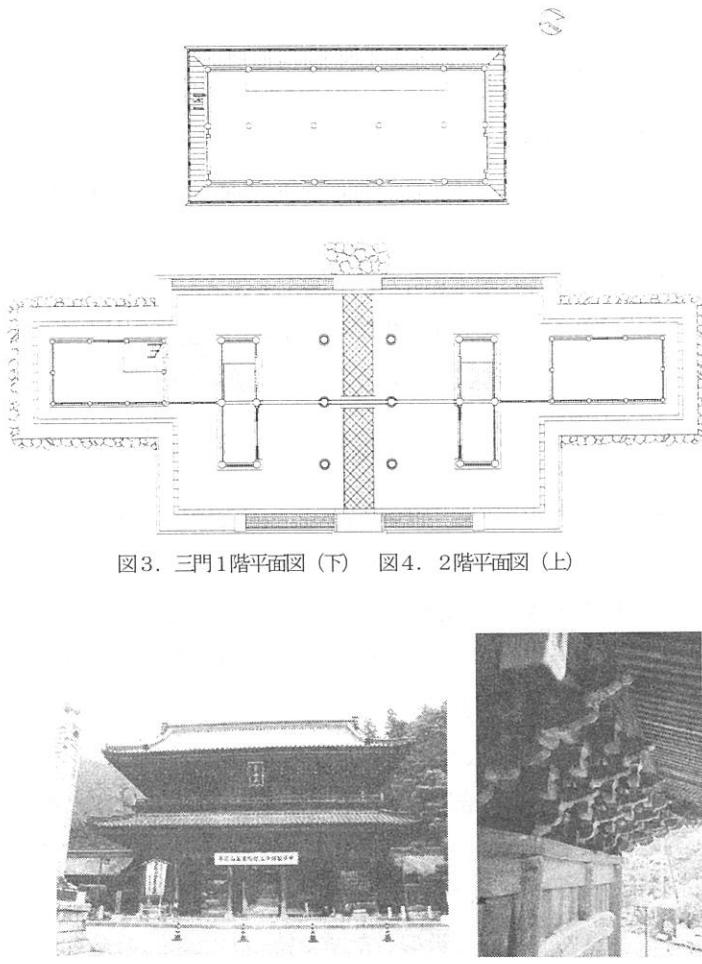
三門1階平面図(下) 図4. 2階平面図(上)
